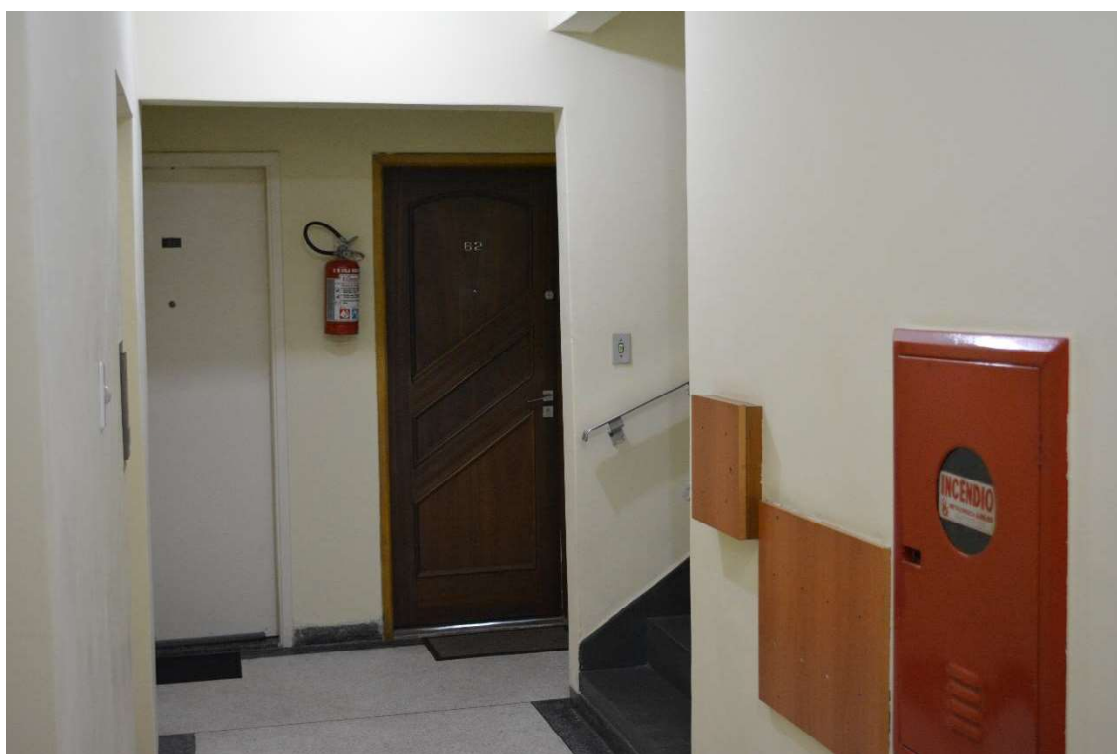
HALL DO 6º PAVIMENTO, VISTA OPOSTA.
